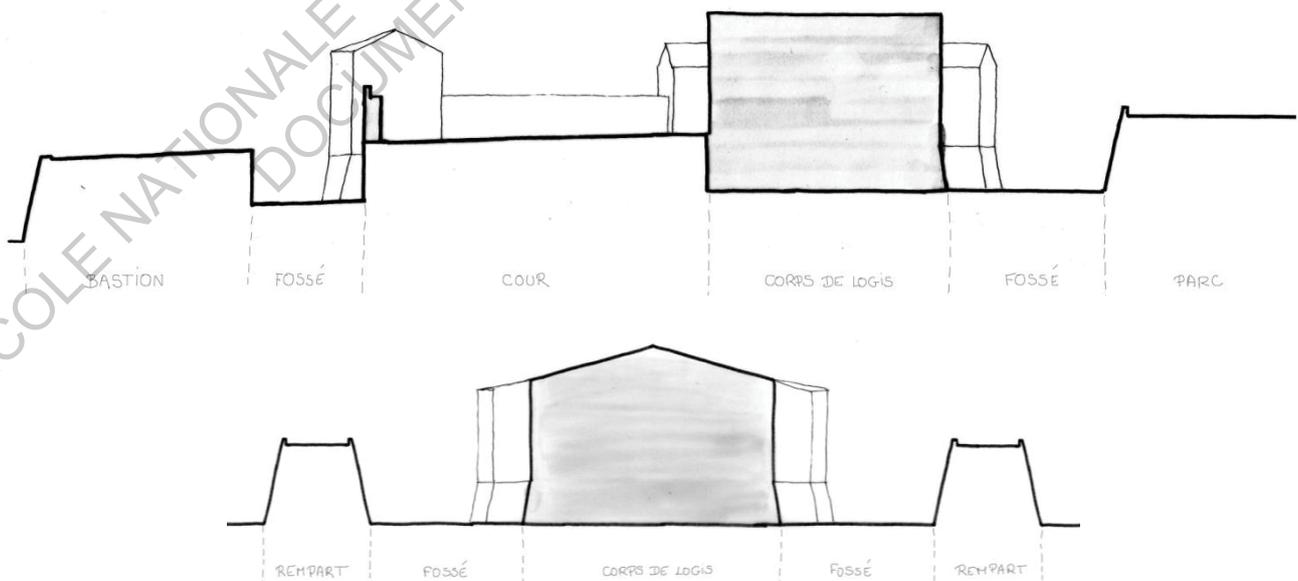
Coupe longitudinale (en haut) et transversale (en bas).
